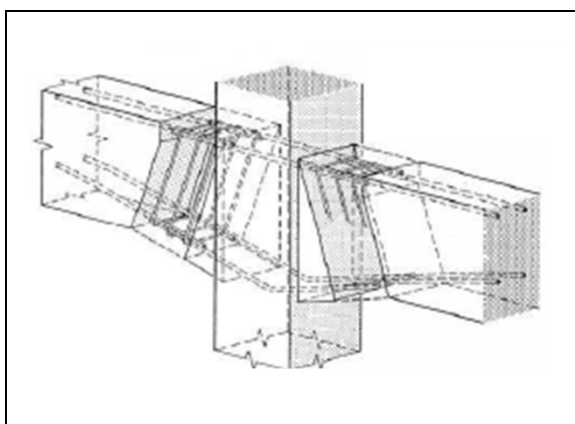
Ligação por betonagem *in situ* (Stupré, 1981)
